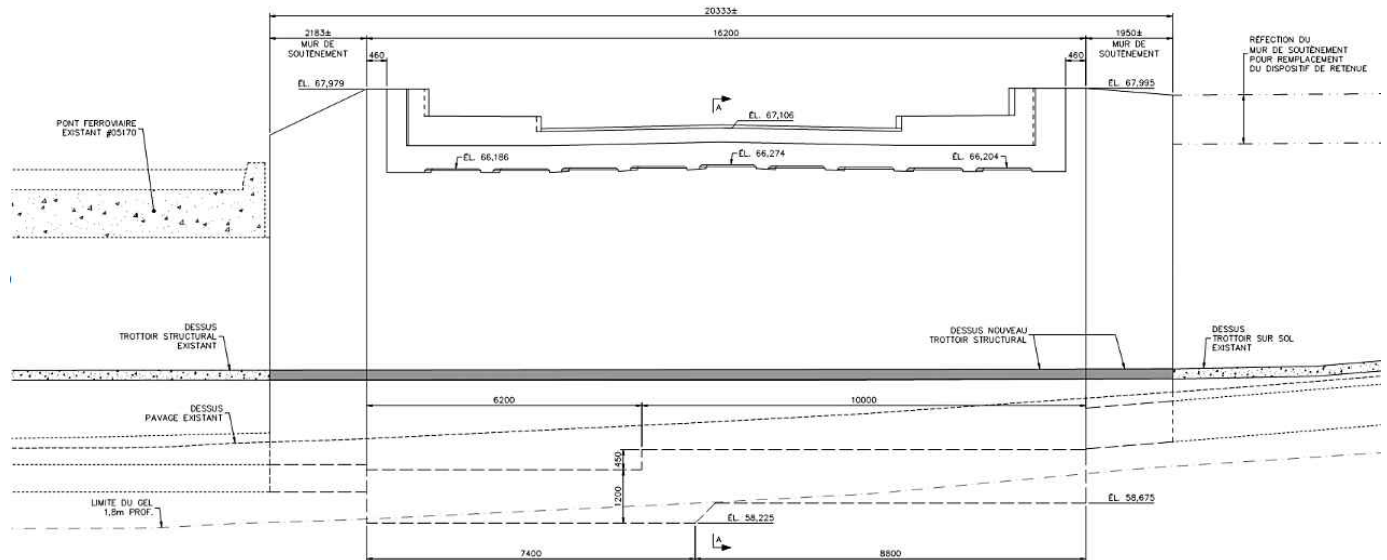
Pont d'étagement routier – Culée proposée axe 1 – Vue en élévation
